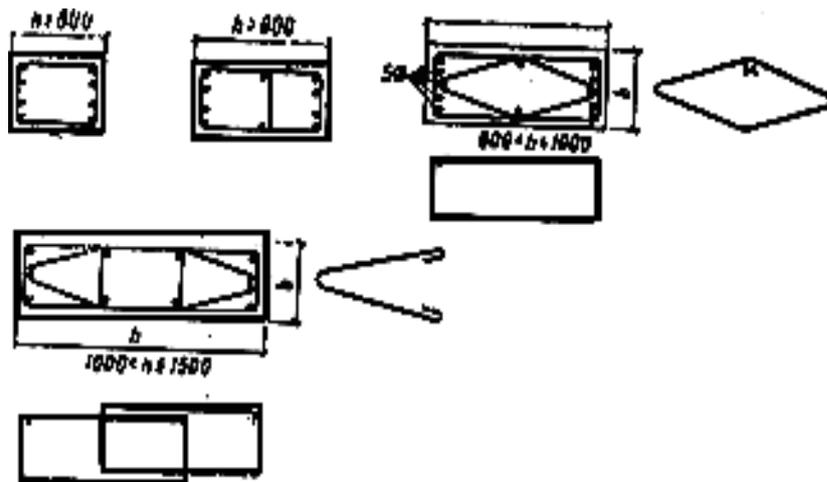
Армирование внецентренно-сжатых колоннпрямоугольного сечения
